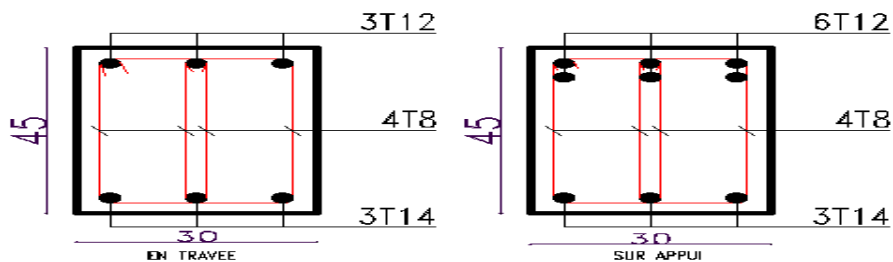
Schéma de ferrailage pour les poutres principales 30x45.
